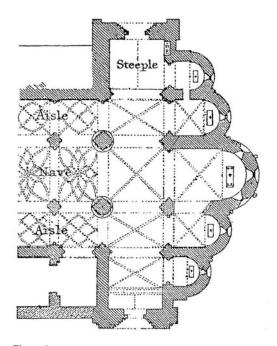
Benavente. Iglesia de Santa María del Azogue, planta del ábside y crucero (Street [1865] 1926)
